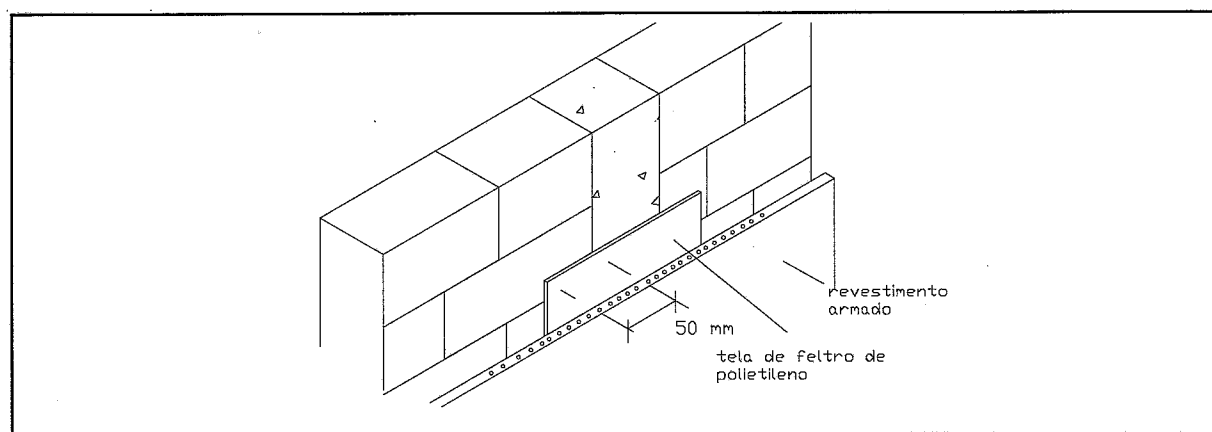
Pormenor da separação dos revestimentos do seu suporte em zona de ligação [43]
